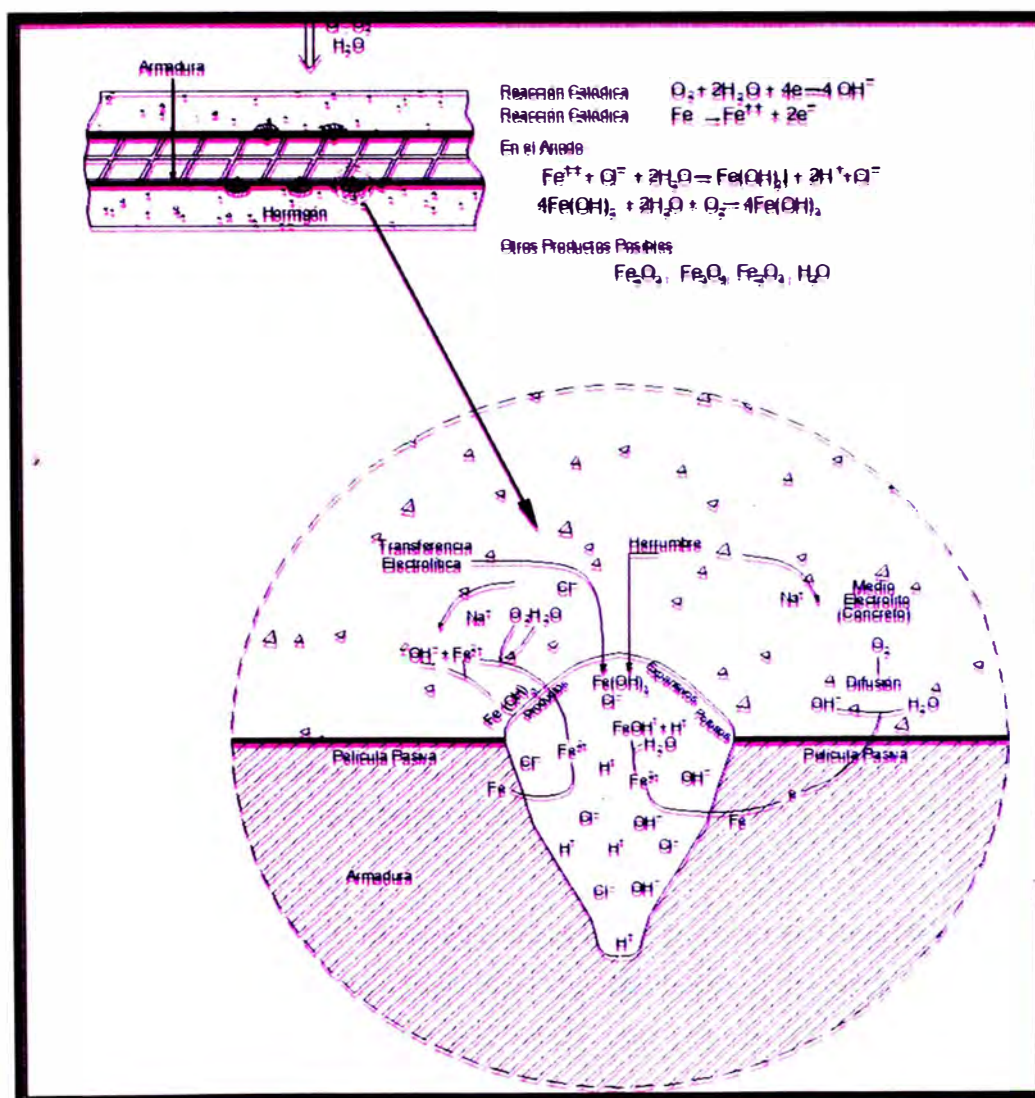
Herrumbre en la barra de refuerzo ocupa más volumen que el acero resultado de presiones internas que producen fisuras en el concreto
